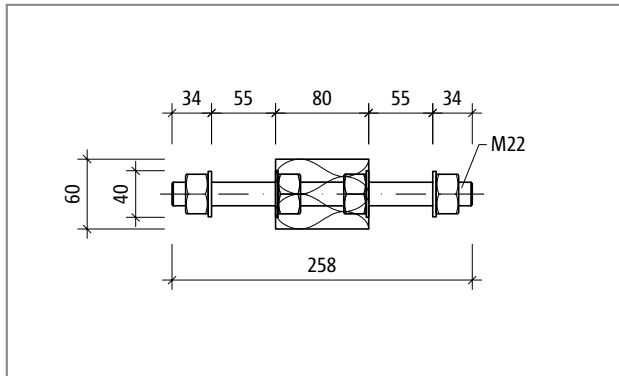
Schöck Isokorb® T Typ S-N-D22: Produktschnitt
